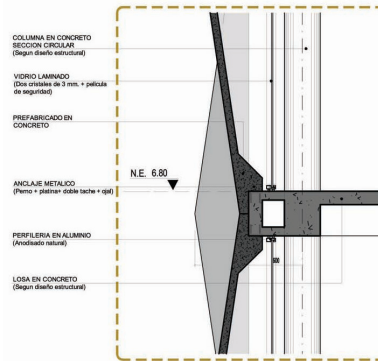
Detalle de sistema prefabricado de hormigón
